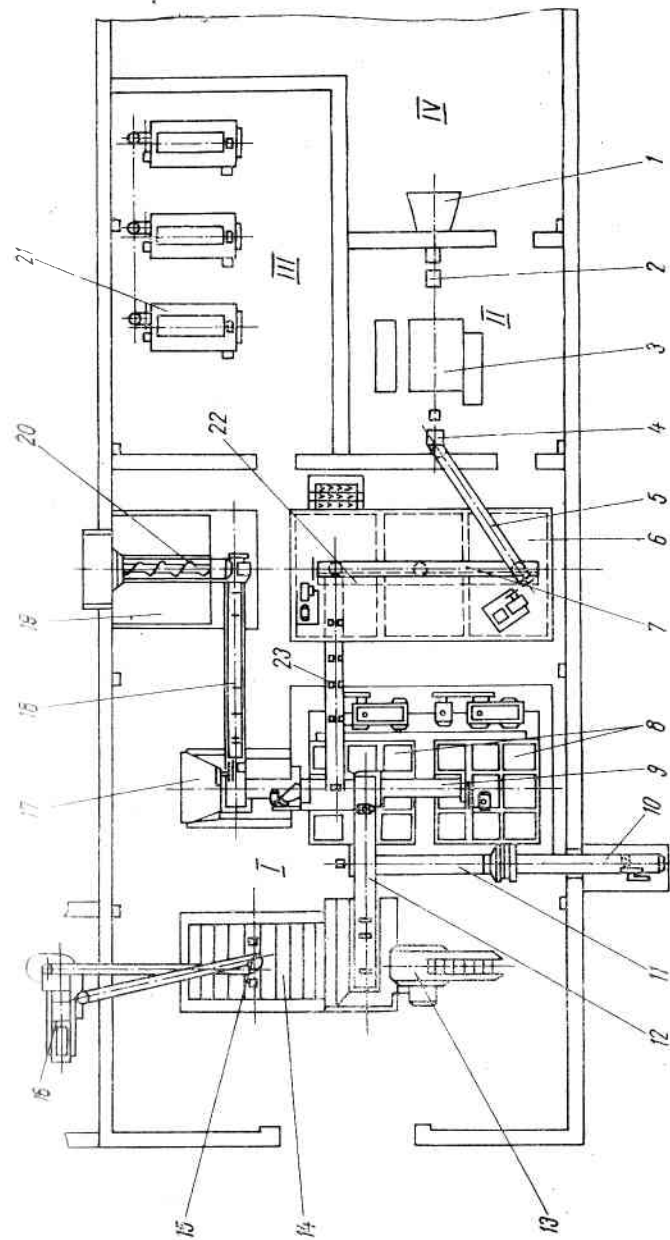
Кормоцех совхоза «Октябрьский» (вид сверху): I — кормоприготовительное отделение; II — размольное отделение; III — котельная; IV — зерносклад;
